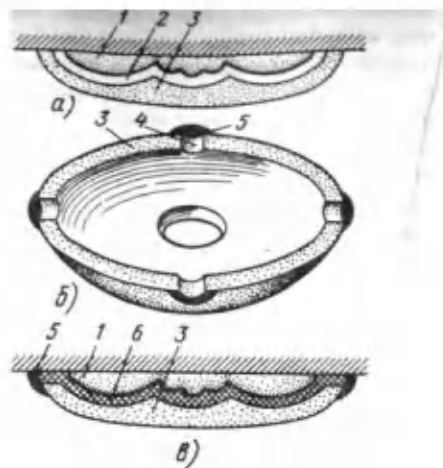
Изготовление клеевой формы с розетки, установленной на потолке: а — разрез кожуха на модели, б — общий вид кожуха, в — разрез формы: 1 — модель, 2 — место для клея, 3 — кожух, 4 — вырезы (отверстия) для выхода клея при расширении, 5 — глина, замазывающая вырезы, 6 — клеевая
